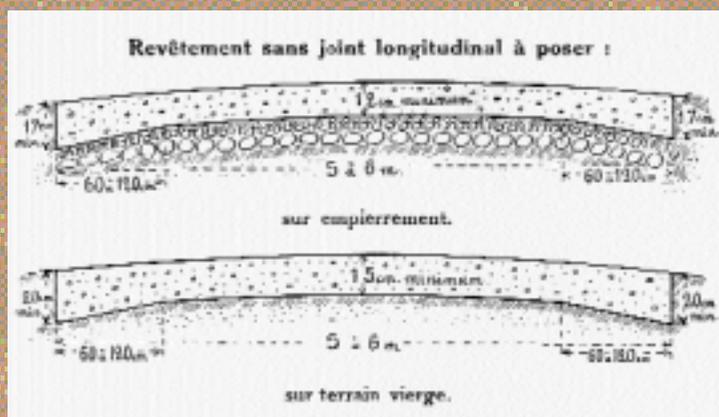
Fig. A : Profil en travers-type de la Drève de Lorraine – source : [3]
